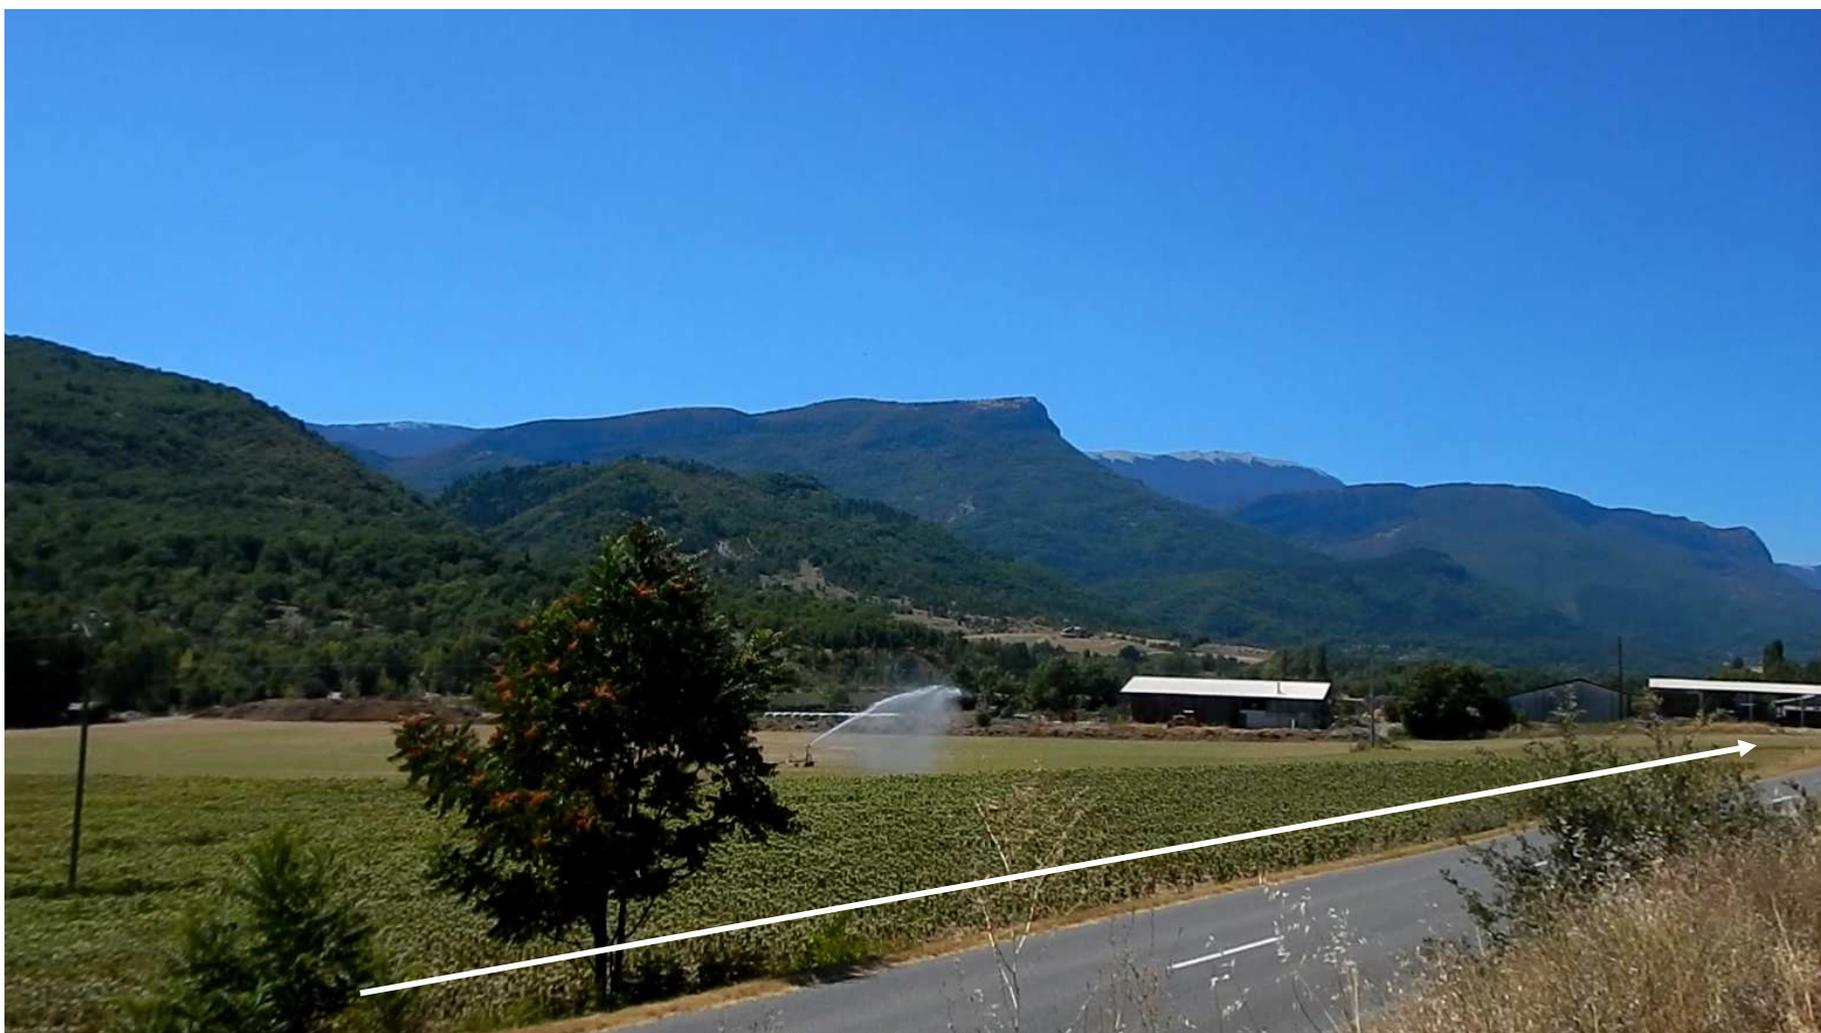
point 1, zone d'implantation d'un réservoir et son accès par une piste existante
